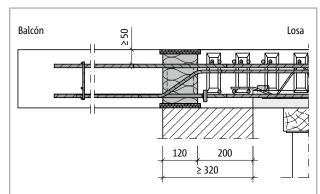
Schöck Isokorb® XT tipo C: Placa prefabricada con apoyo periférico con muro aislante (sección XT tipo C-R-CV50, vista XT tipo C-L-CV35)
